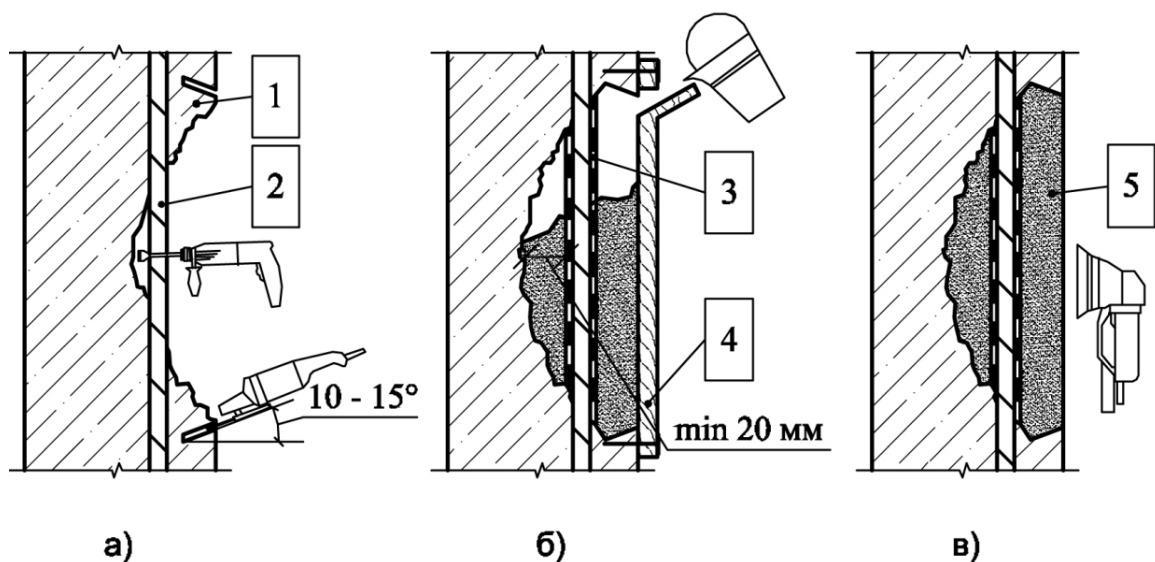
Схема ремонта дефектов бетона с оголением арматуры:
